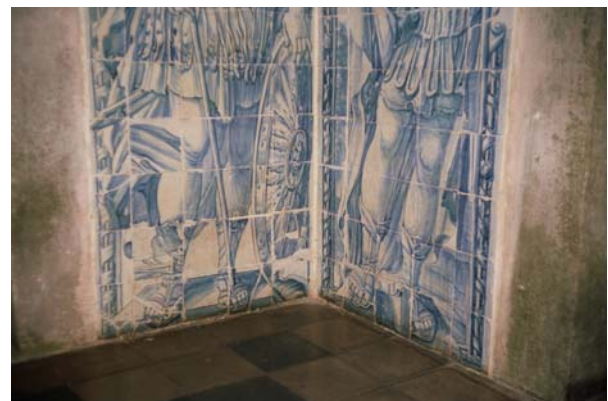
Detalhe situação de patologias do painel do claustro do pavimento inferior.
